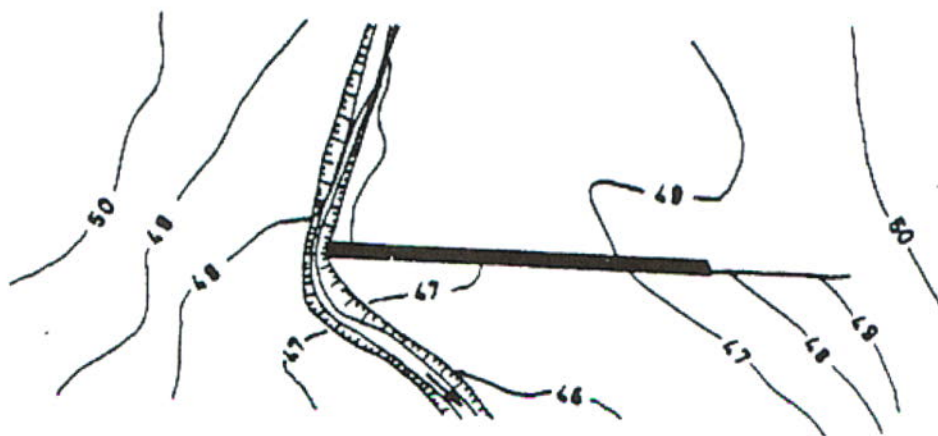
IMAGEM ADAPTADA DO TRAÇADO EM PLANTA DA BARRAGEM DE PISÕES - QUINTELA ET AL. 1985
